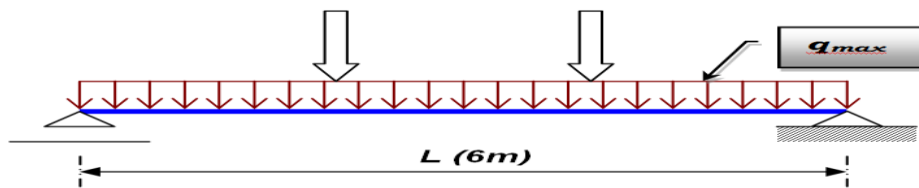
schéma statique de la poutre principale la plus sollicitée
